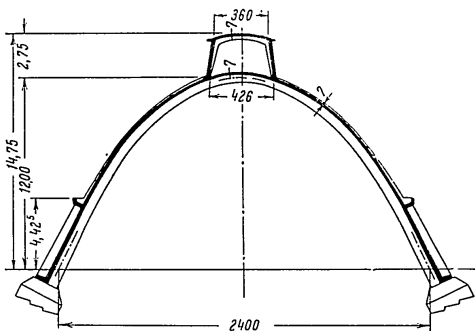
Склад сыпучих в виде тонкостенной железобетонной оболочки (Чехословакия)
